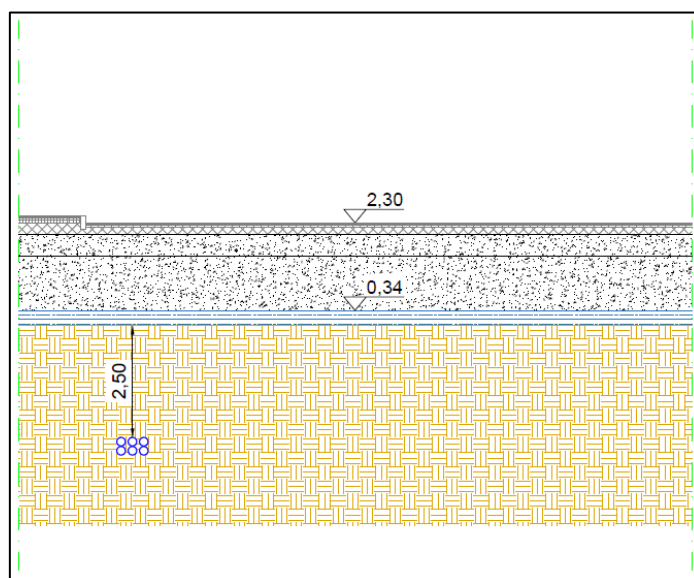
Sezione tipo (estratto coldLI-PD-EG15-06-REV00)
